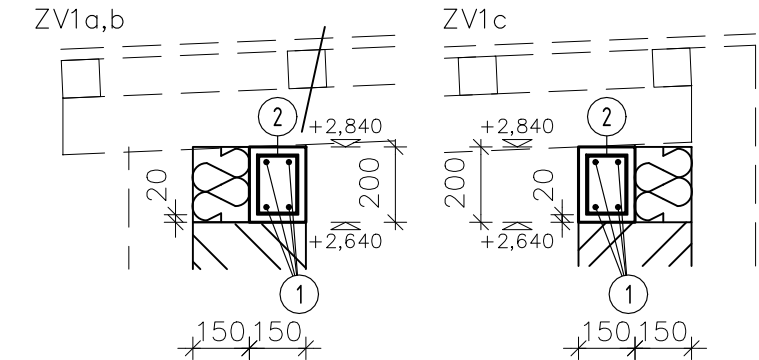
SVÁZÁNÍ ROHU VĚNCŮ – 4ks
